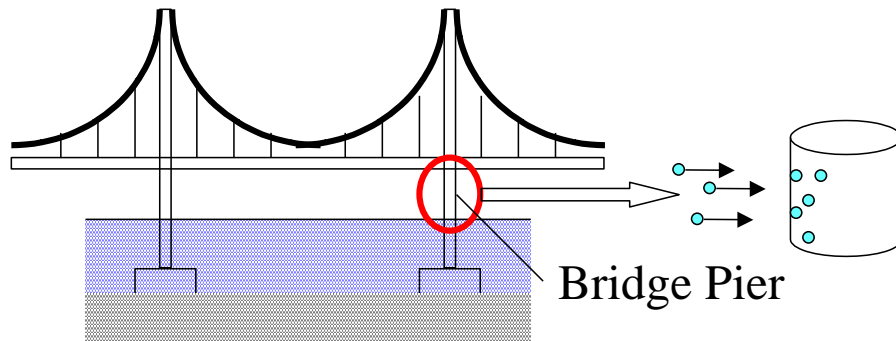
コンクリート橋に於ける付着塩分量調査例¹⁴⁾
